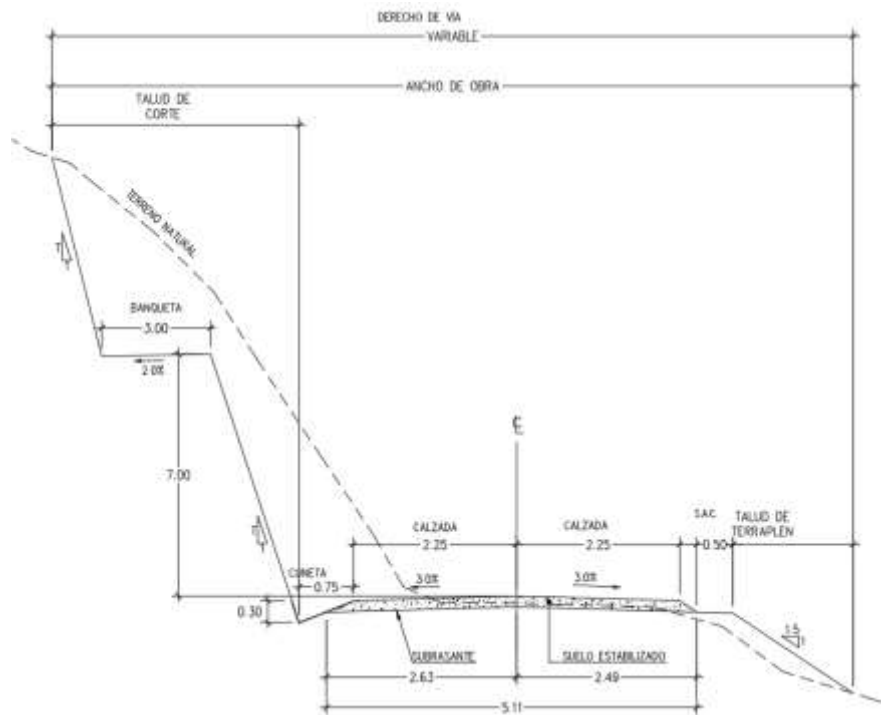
Sección típica con banquetas de corte. Fuente:Plano de secciones típicas.
